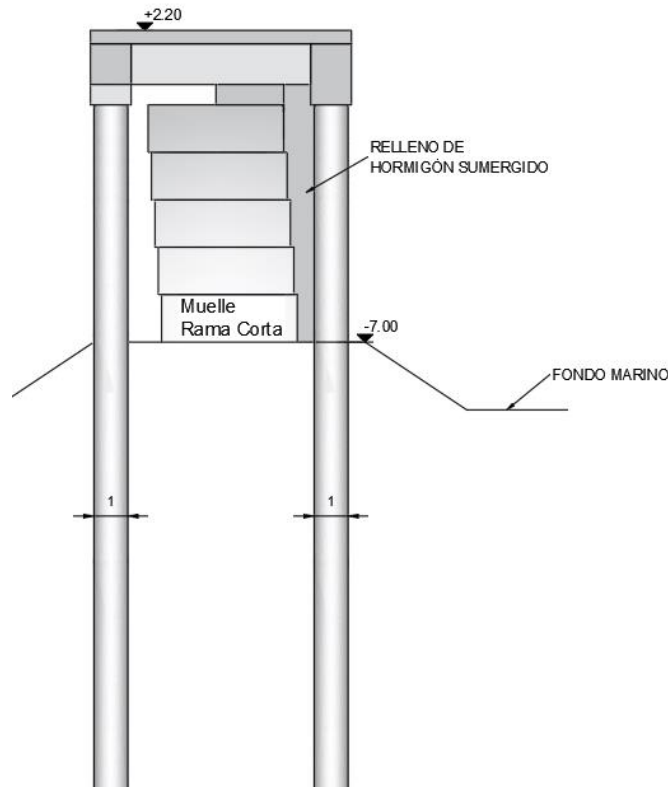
Sección tipo de alternativa de muelle en estructura pórtico. Fuente: Estudio de alternativas desarrollado por IDOM, noviembre 2021
